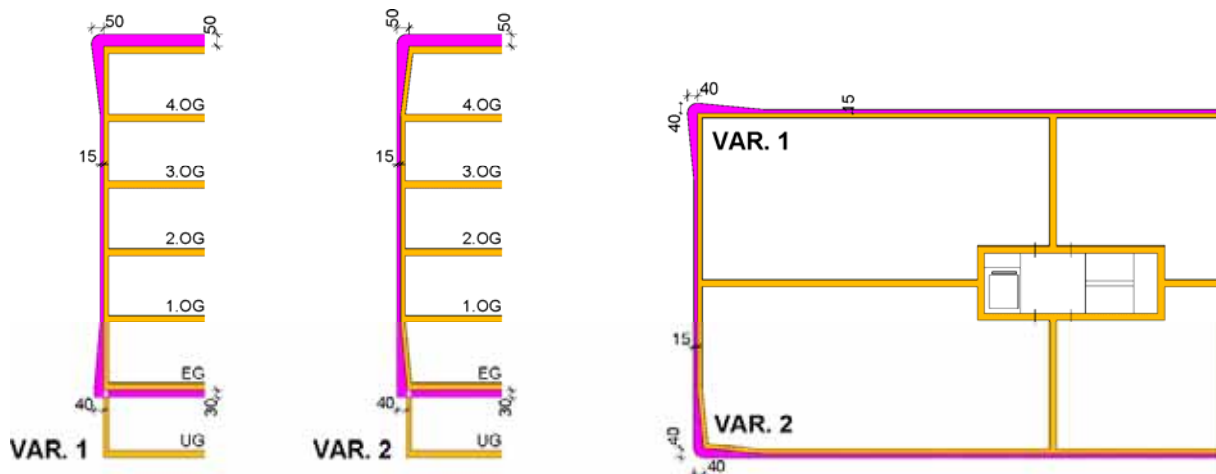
Schnitte und Grundriss (Schema) mit örtlich angepasster Dämmstärke
